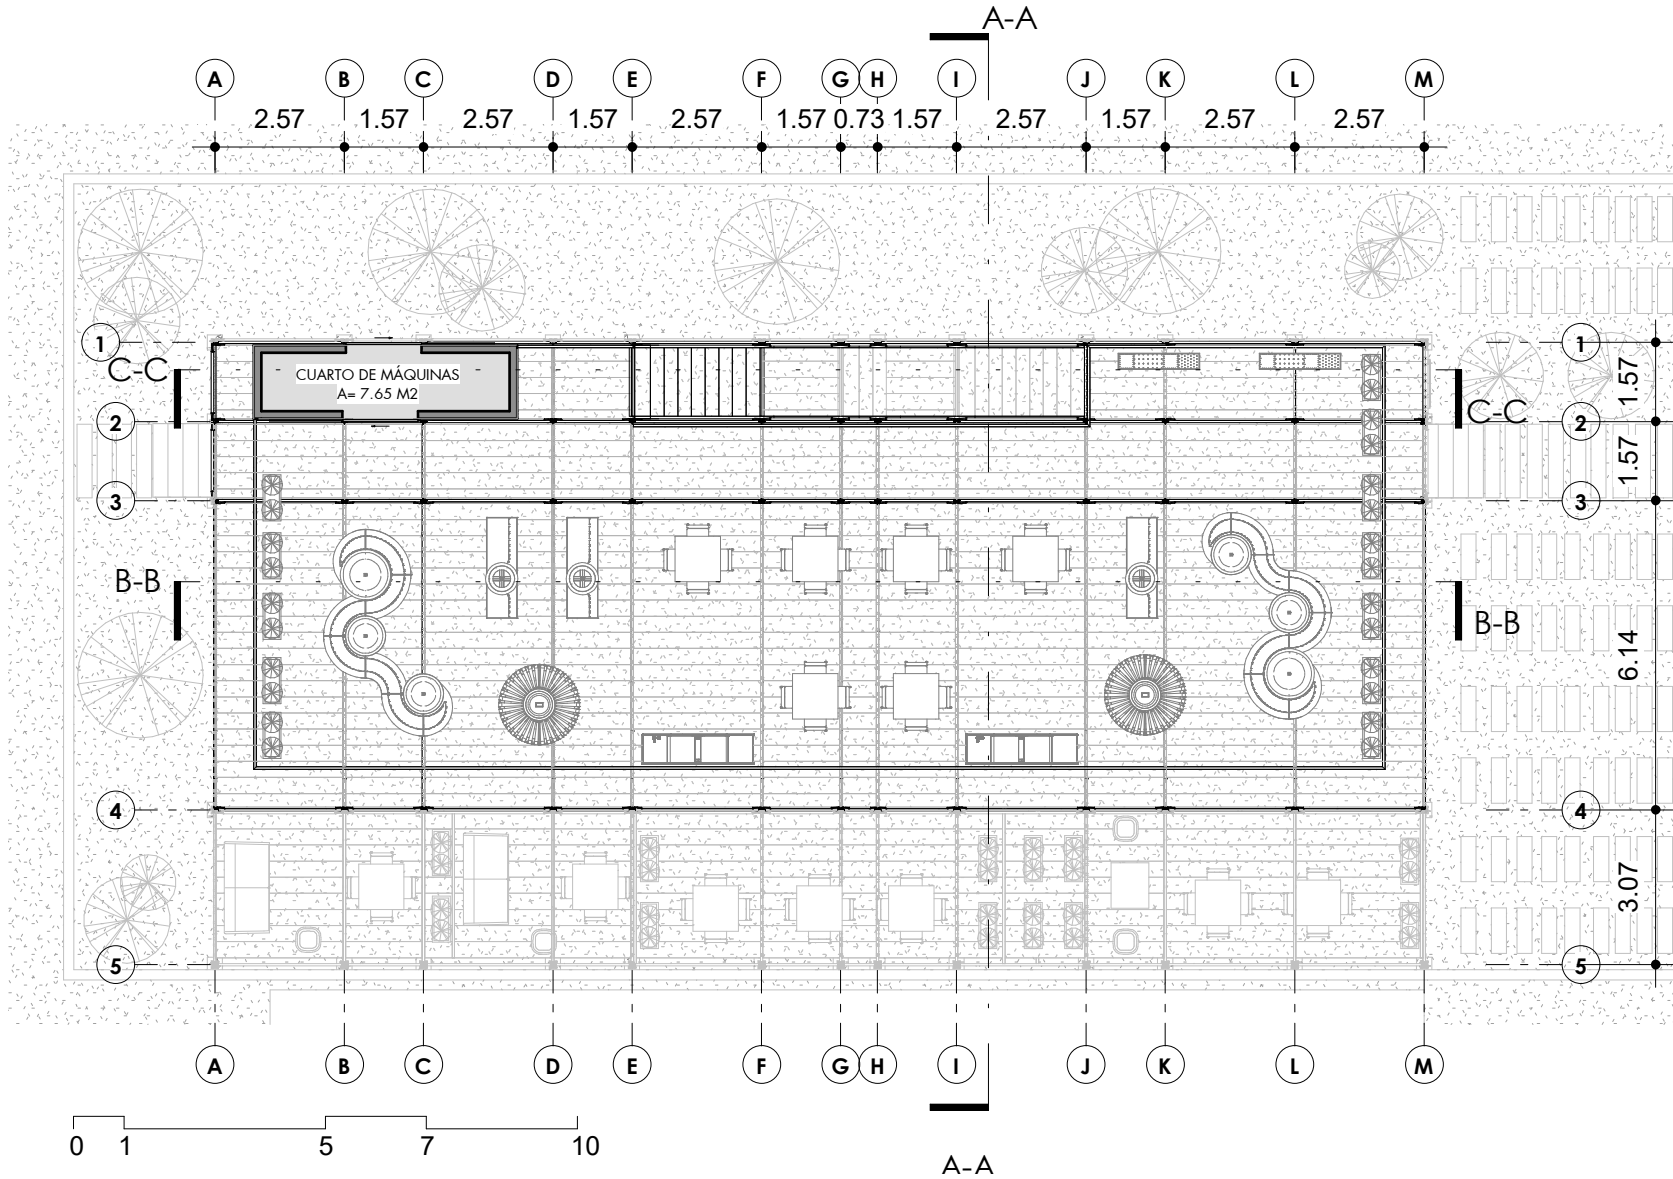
Planta De Cubiertas y Emplazamiento
